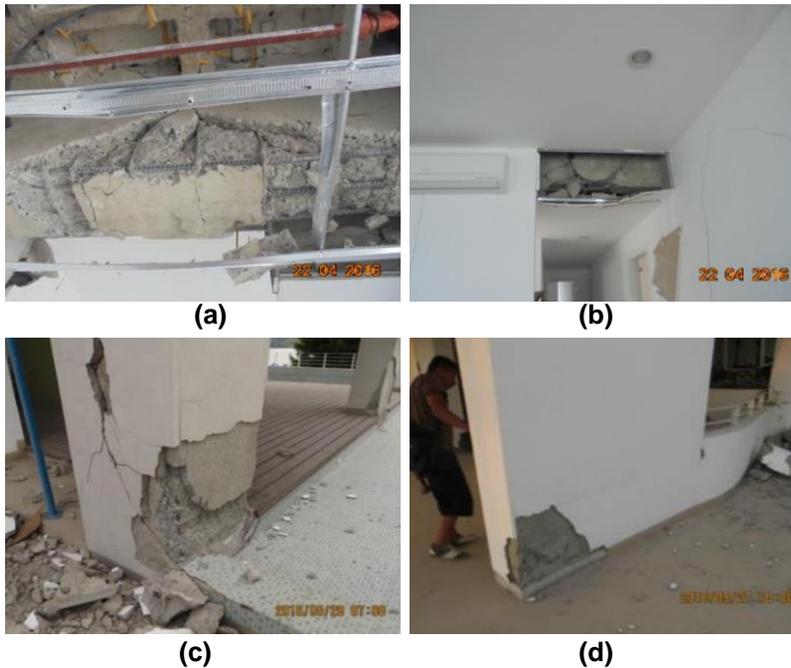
, Daño en elementos estructurales: a) Daño en viga del segundo piso; b) Daño en viga del tercer piso; c) Daño en columna del segundo piso; d) Daño leve en nudo inicial de muro.
